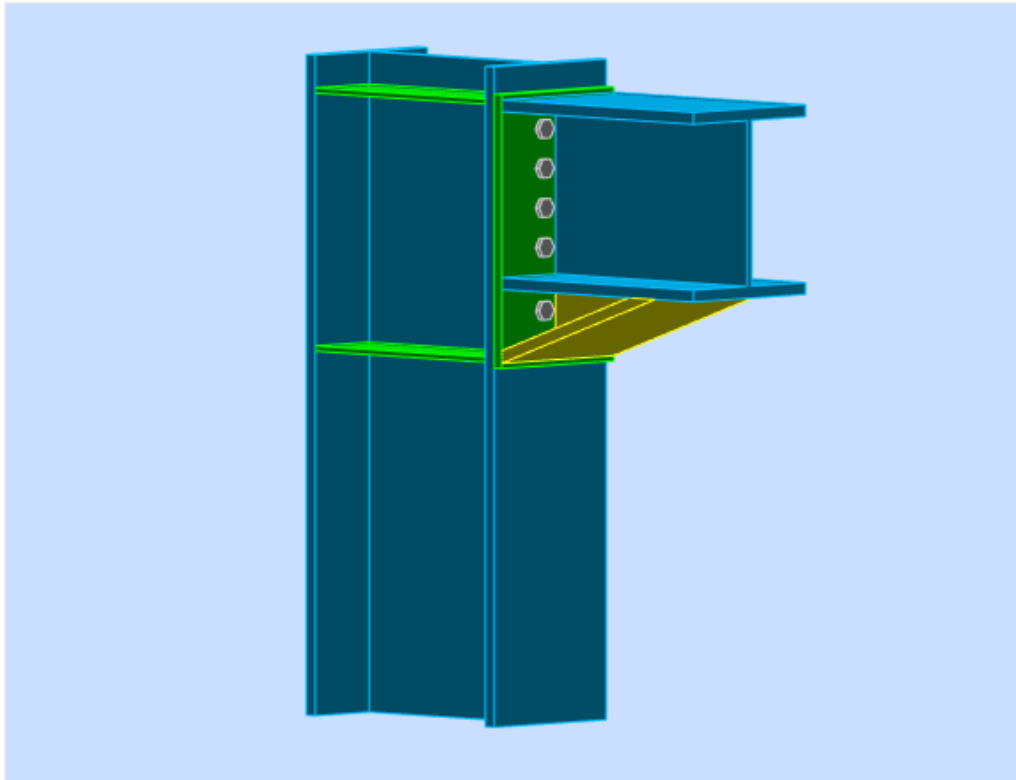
Assemblage poteau-console de la poutre de roulement
